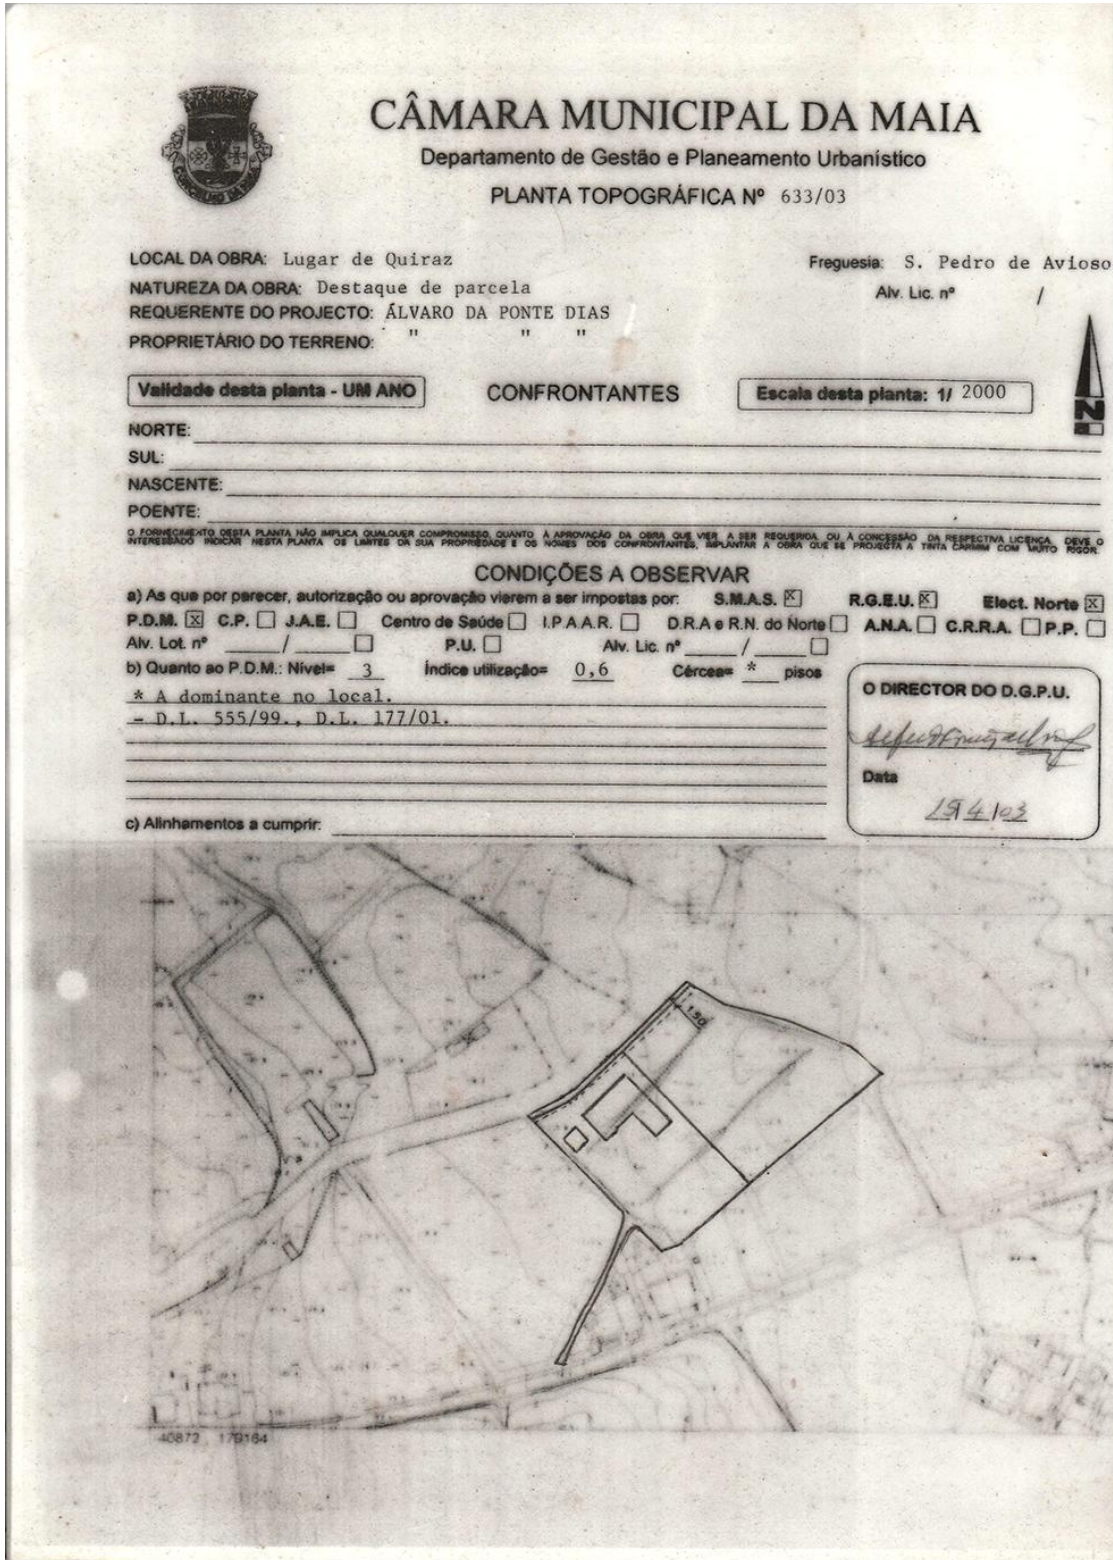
Planta Topográfica com divisão de parcelas do terreno
